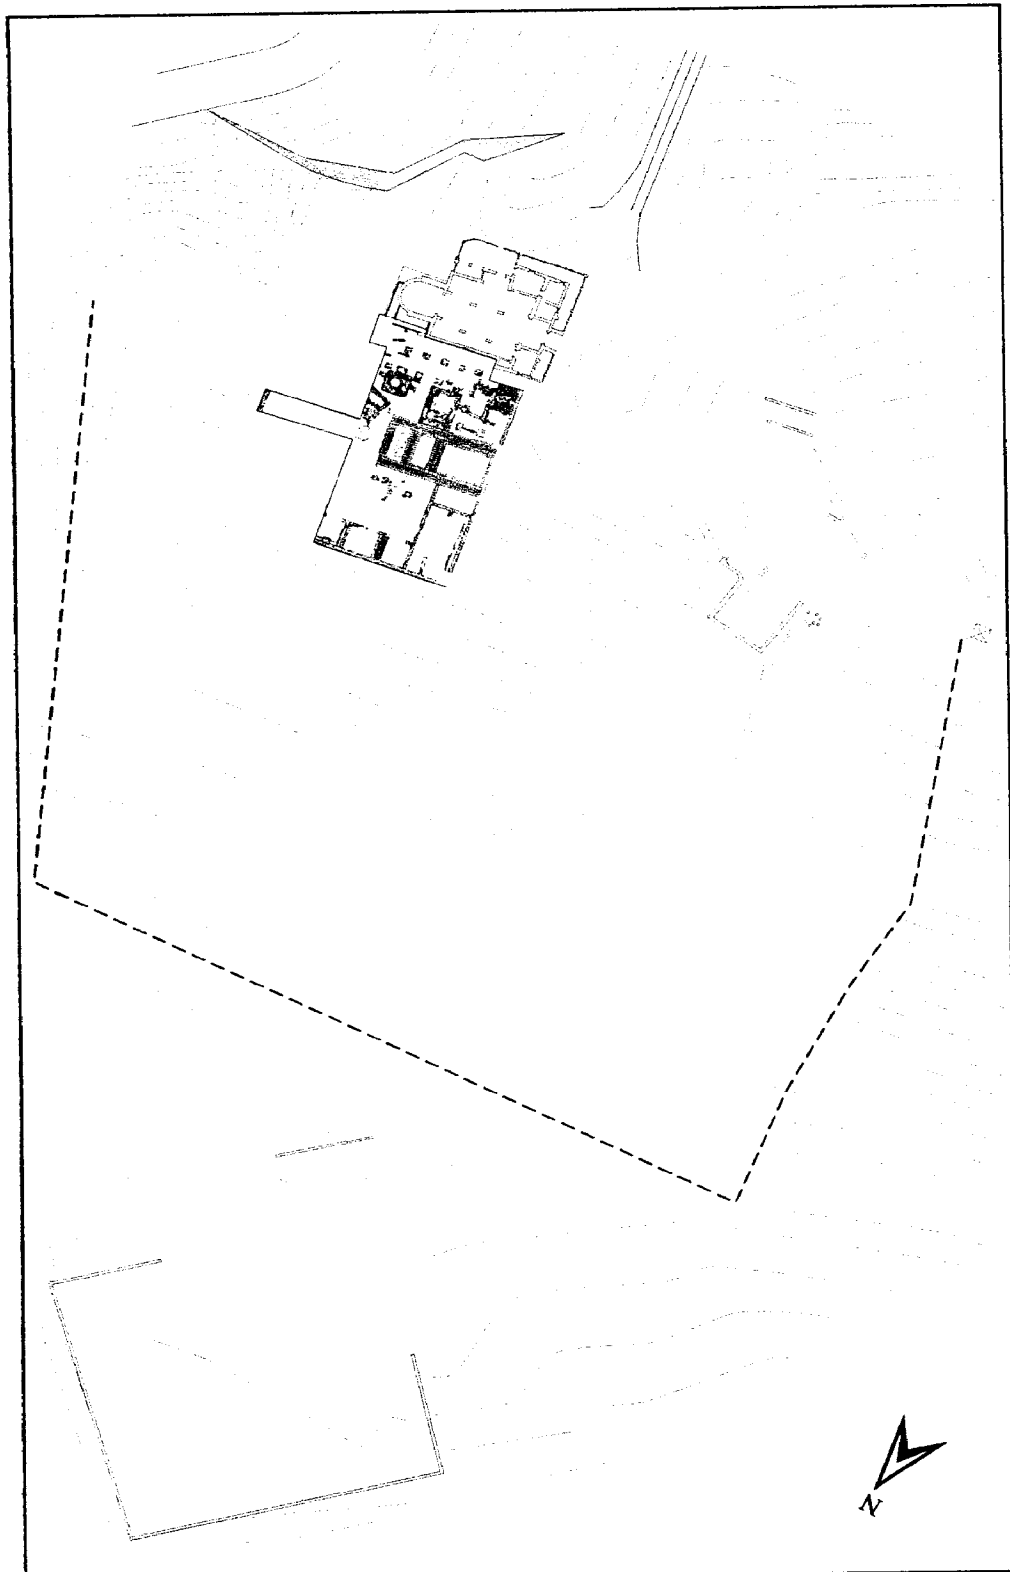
Proyecto "Turobriga". Planta con las estructuras documentadas en la ciudad.
